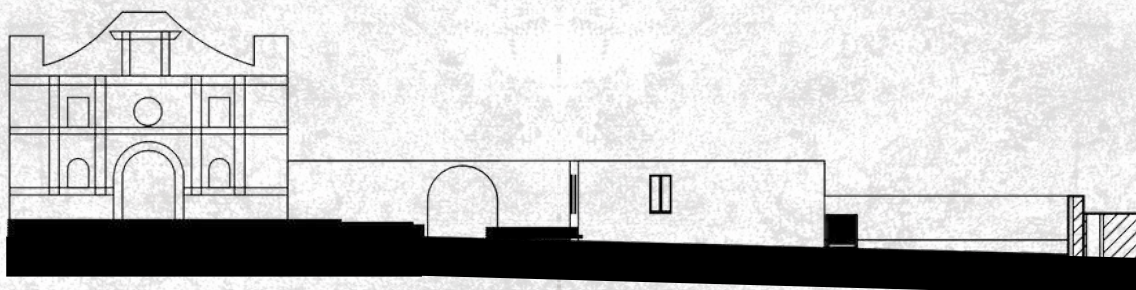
Ubicación y levantamiento técnico de fachada 1 Este tramo 1
